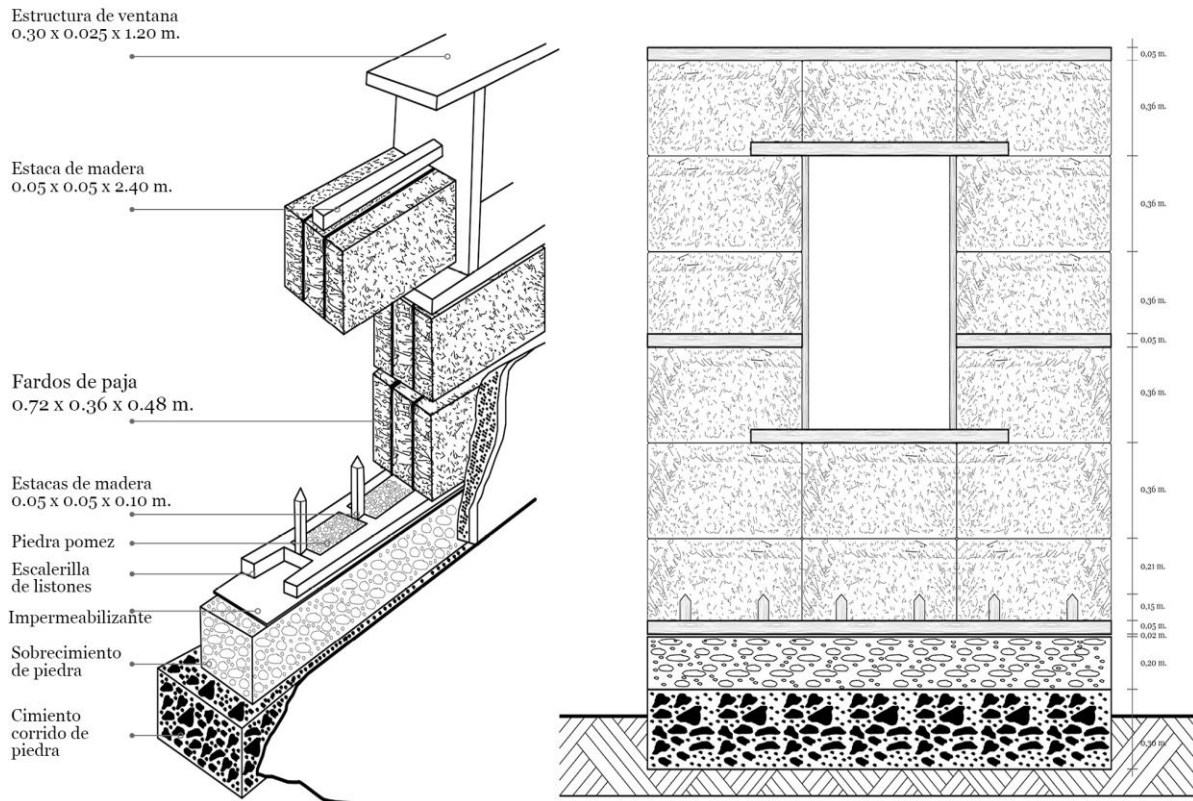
Detalles de fardos paja aplicados en caso de estudio.
